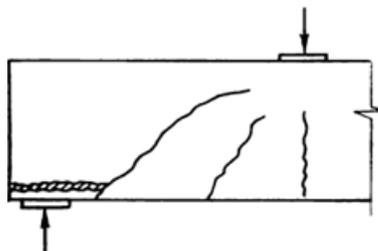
Разрушение в зоне анкеровки по растянутой зоне [1]
